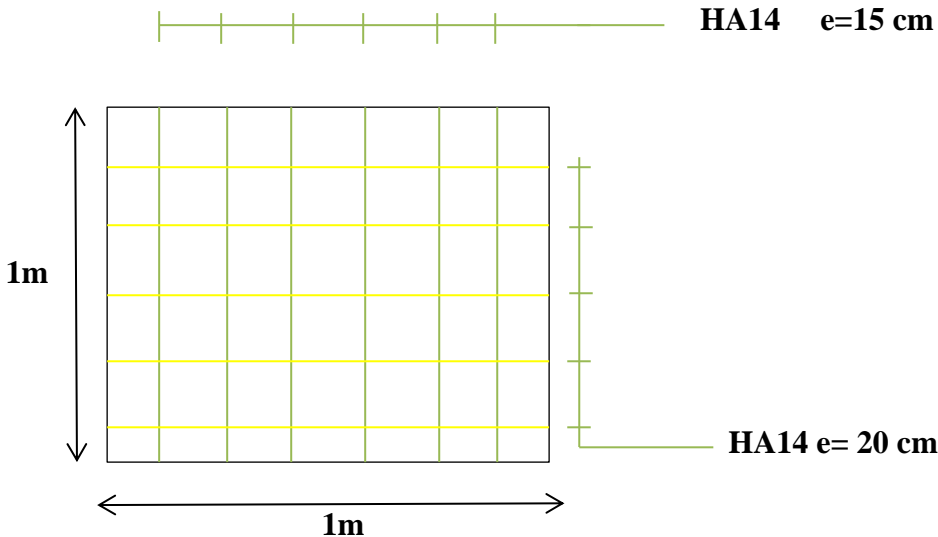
Ferrailage nappe supérieur (travée)
